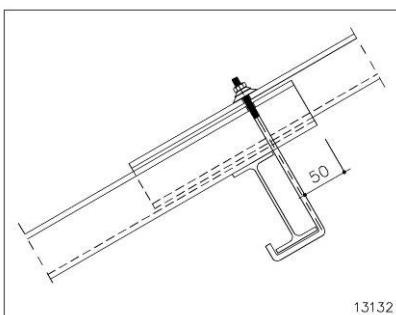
Fixation avec boulon-crochet à hauteur du recouvrement longitudinal
